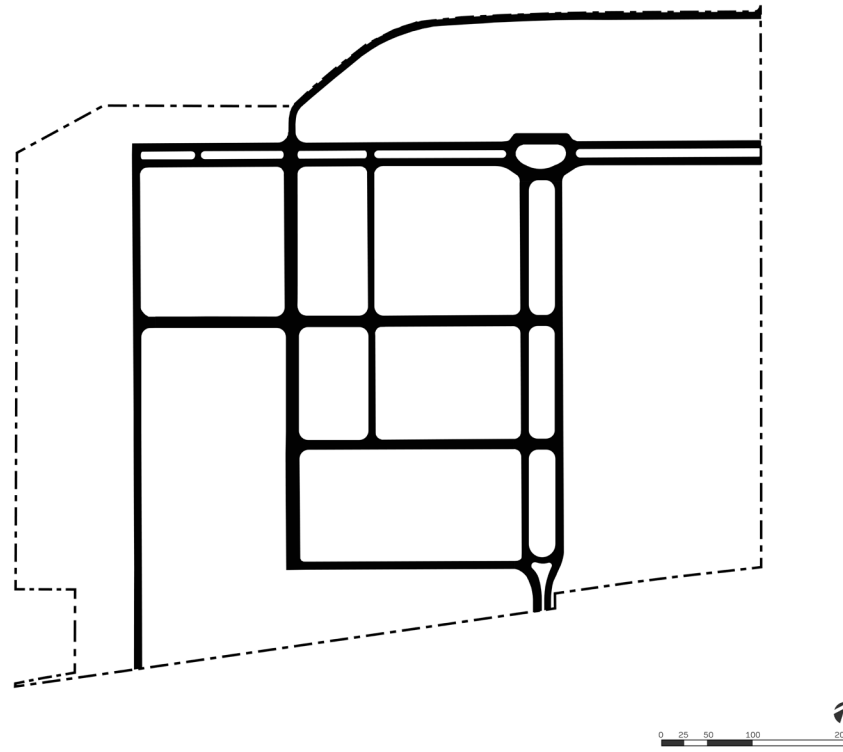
Plan de la figure-fond du réseau de rues existant
